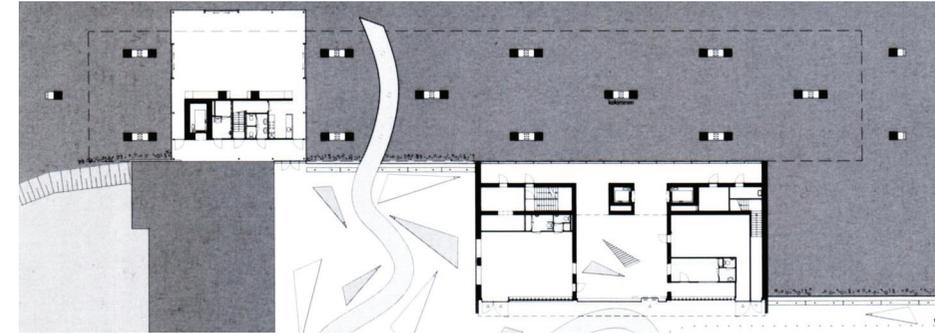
Grundriss Erdgeschoss M 1:1250
